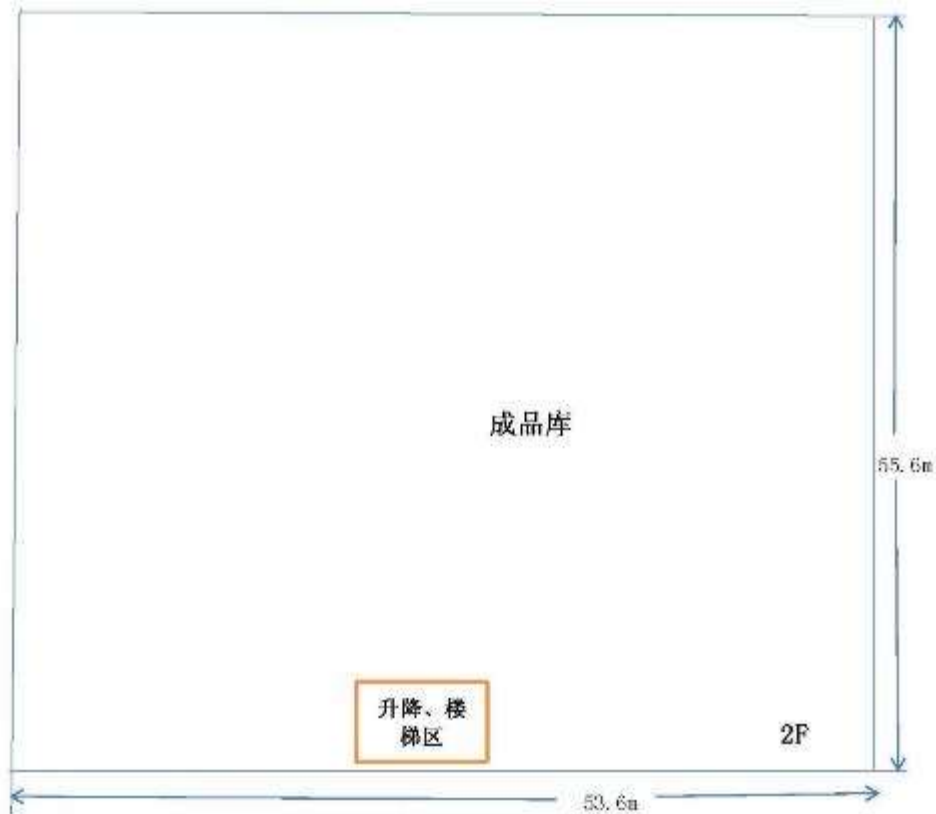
搬迁及改扩建后北厂区 1# 厂房二层平面布置图
